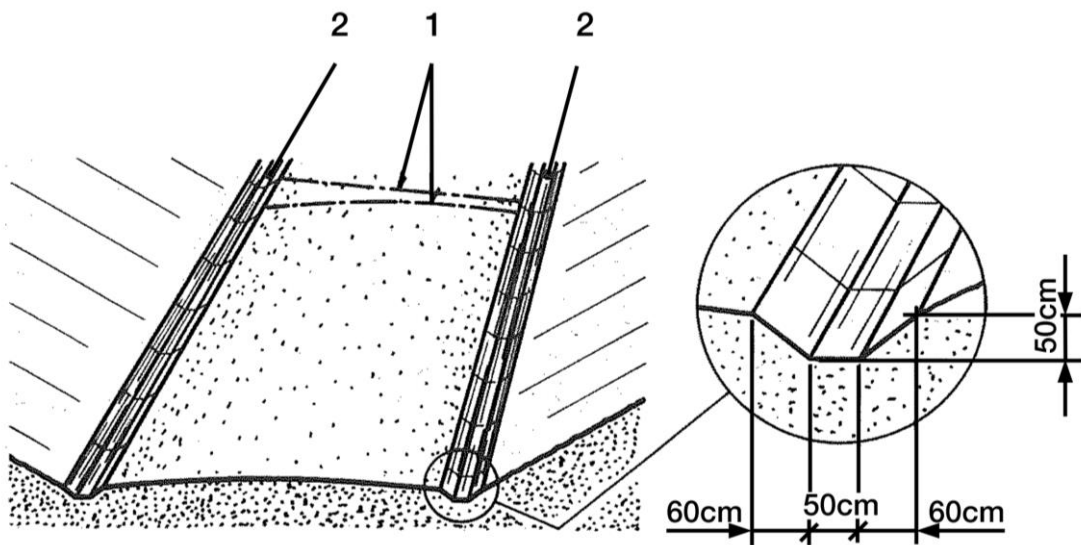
Weg mit Seitengraben / Detail Seitengraben
